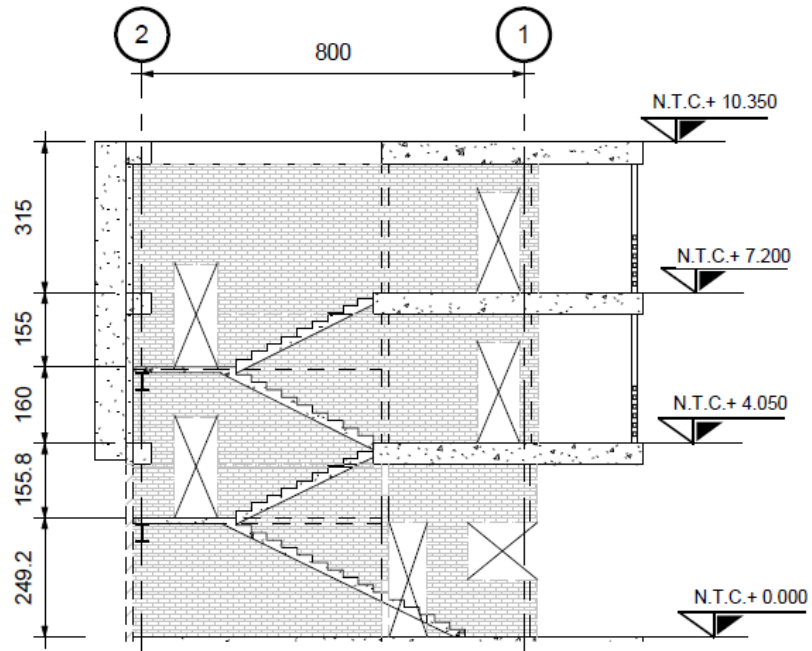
Sección transversal, zona de escaleras del Edificio ING-4. Fuente autoría propia, 2023.
